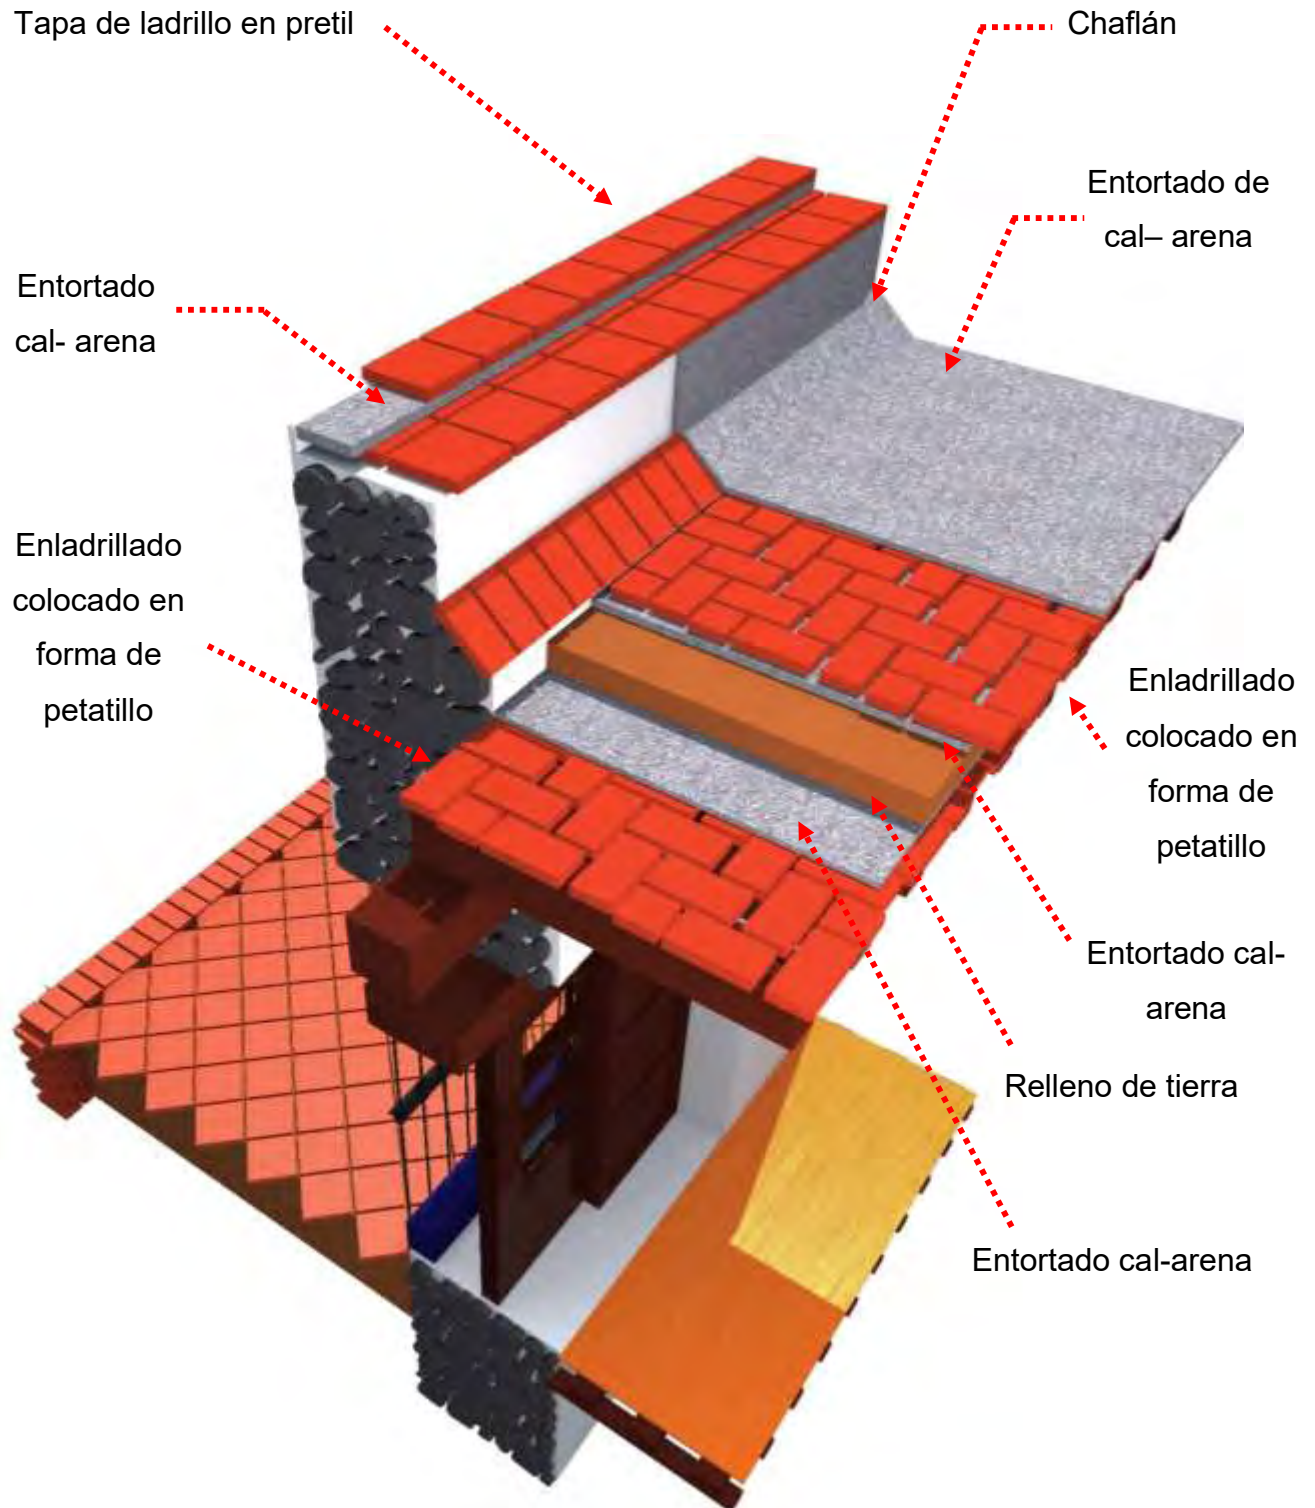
Detalle del sistema constructivo de la cubierta de la Casa del Hacendado.
